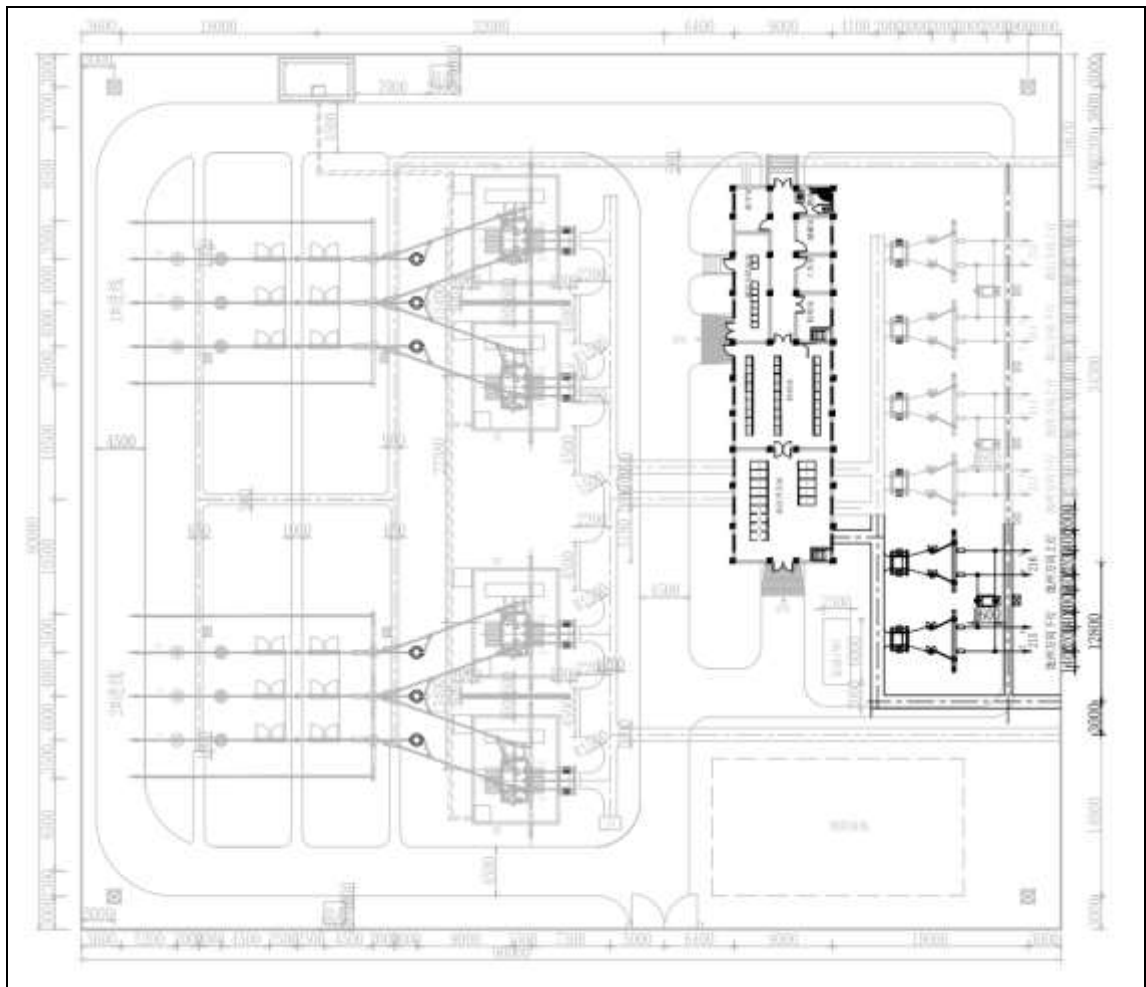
既有九华山 220kV 户外牵引变电所总平面布置图
